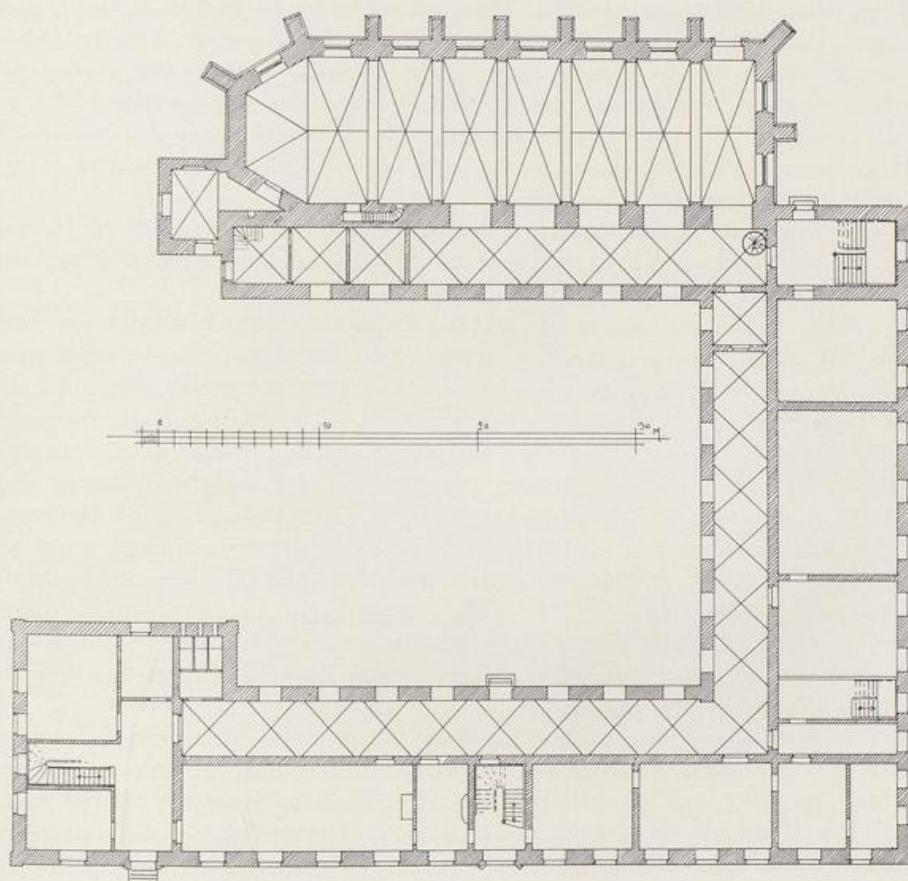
Füssenich. Grundriss des Klosters und der Kirche.
